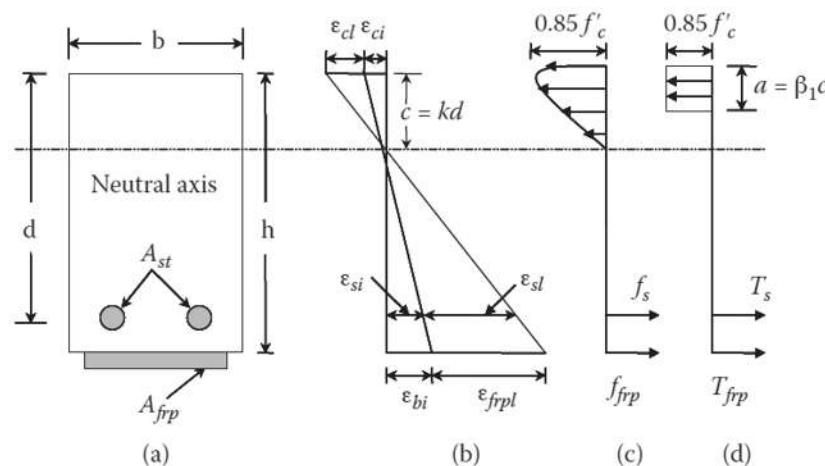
Distribución de la deformación y condiciones de equilibrio de las fuerzas en una viga de concreto reforzado mediante FRP: a) sección transversal de la viga, b) distribución de la deformación, c) distribución del esfuerzo parabólico, d) distribución del esfuerzo rectangular equivalente. (GangaRao, Taly, & Vijay, 2007)
